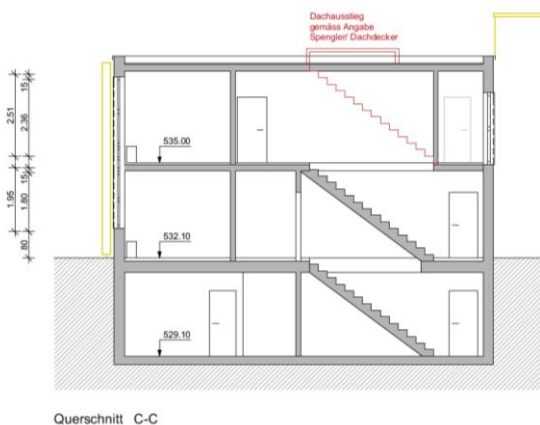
Gebäudeschnitt mit Abbrüchen (gelb) sowie zusätzlichem Dachausstieg (rot)
